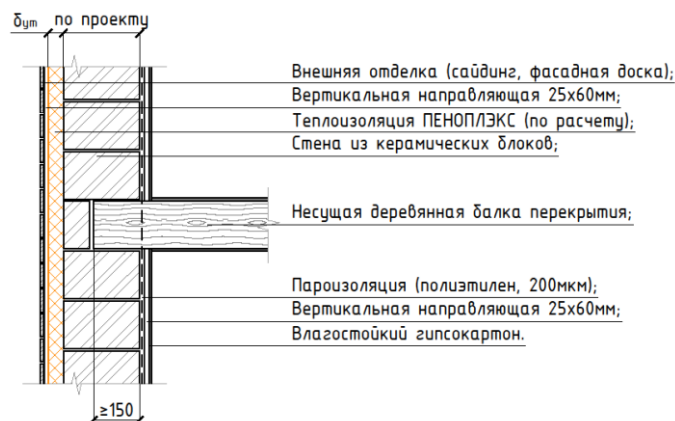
Схема сопряжения стены из керамических блоков с деревянным перекрытием (плиты ПЕНОПЛЭКС с внешней стороны).
